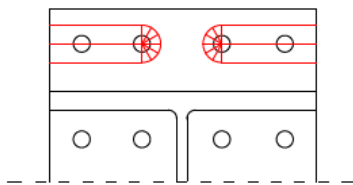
Abmessungen des T-Stummels mit vier Schrauben in einer Reihe [20]
